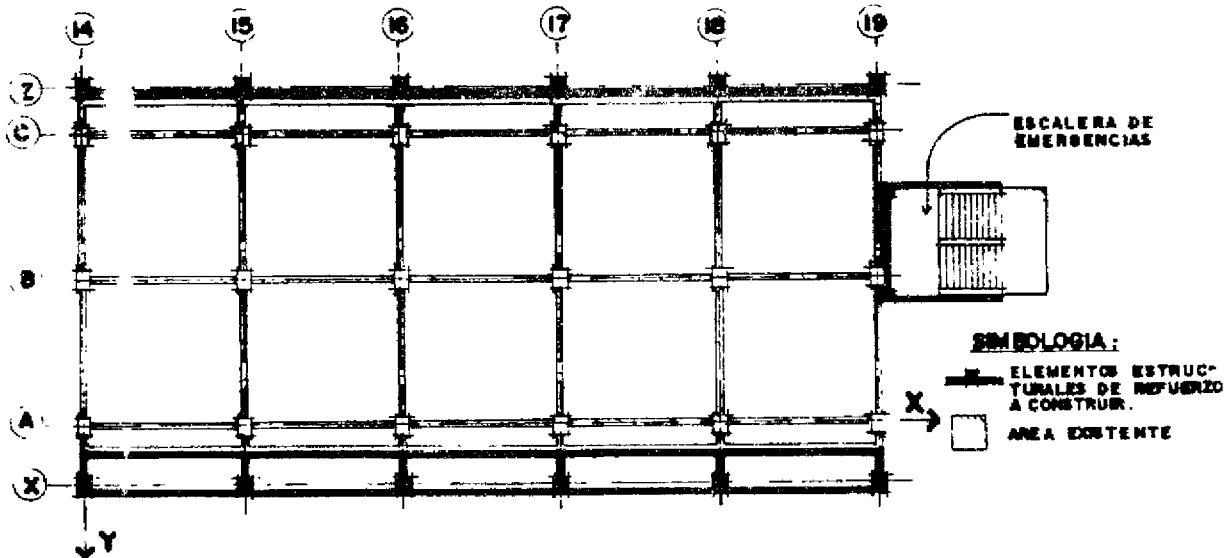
PLANTA ESTRUCTURAL TIPICA EDIFICIO NOR-OESTE Y ESCALERA DE EMERGENCIAS
